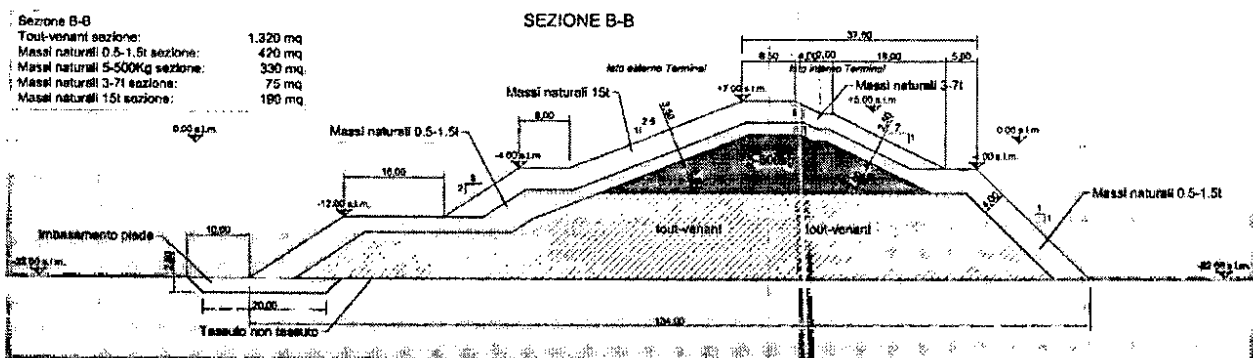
Diga foranea – Sezione Tipo B-B. Fonte SIA
